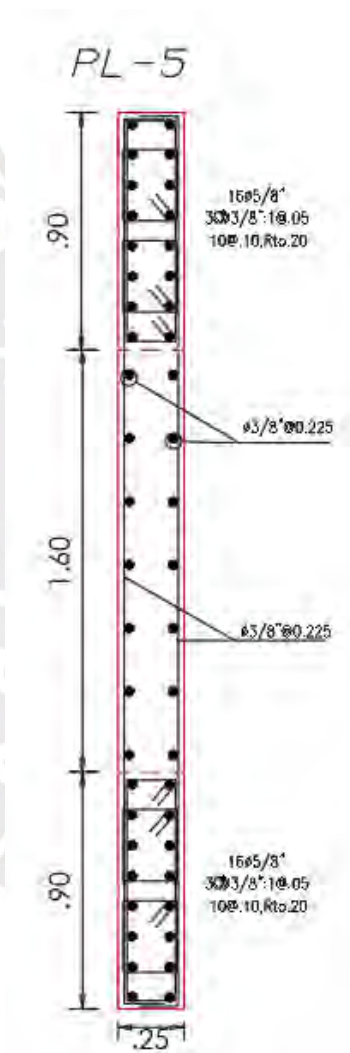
Disposición final de refuerzo de acero longitudinal y estribos
